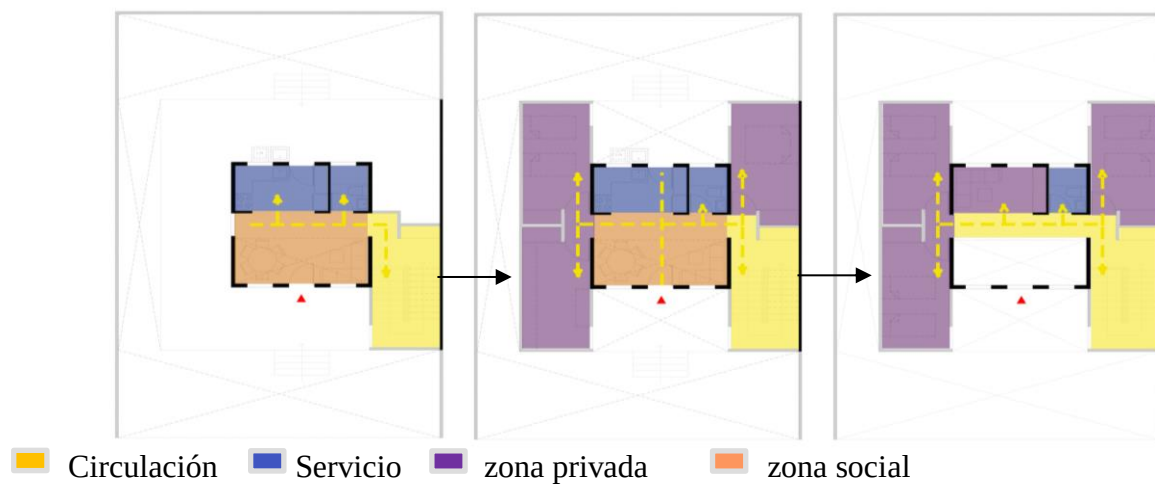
Plantas arquitectónicas esquema con segundo piso.
